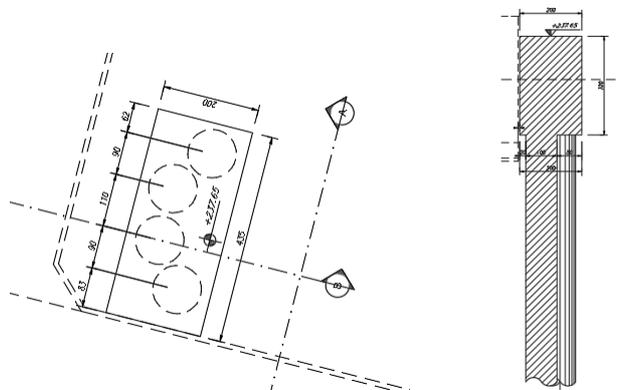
Pianta e sezione dell'opera di protezione dall'urto del treno
